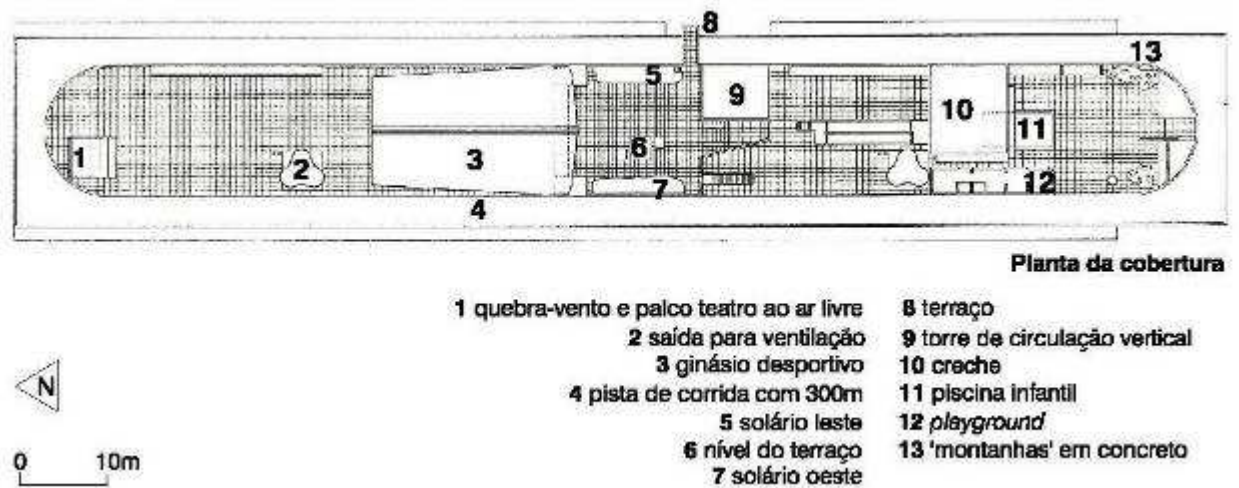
Planta do terraço na cobertura: uso comunitário.
